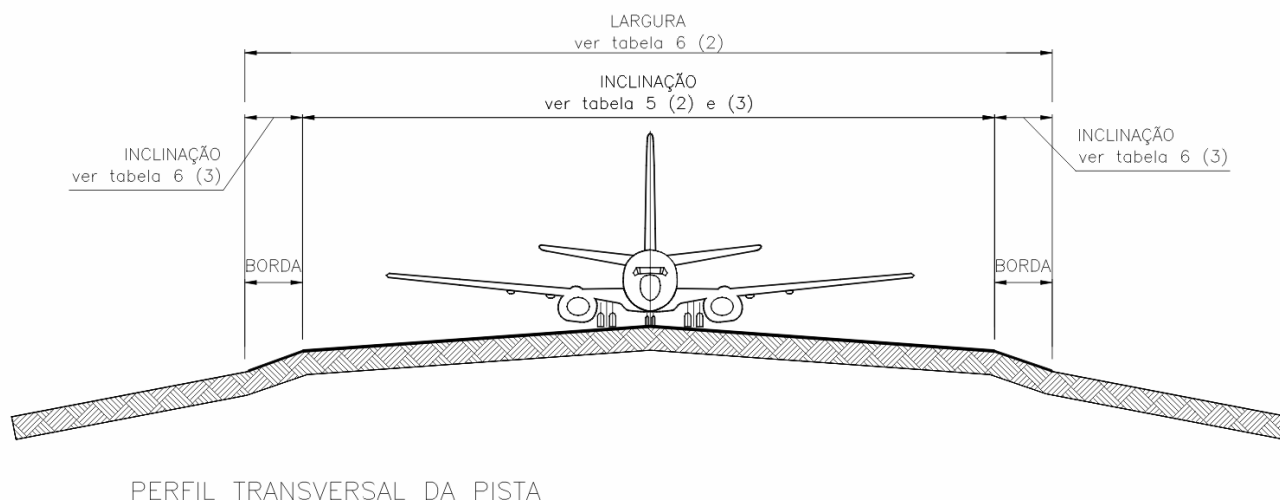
Inclinações transversais em pistas de pouso e decolagem.
